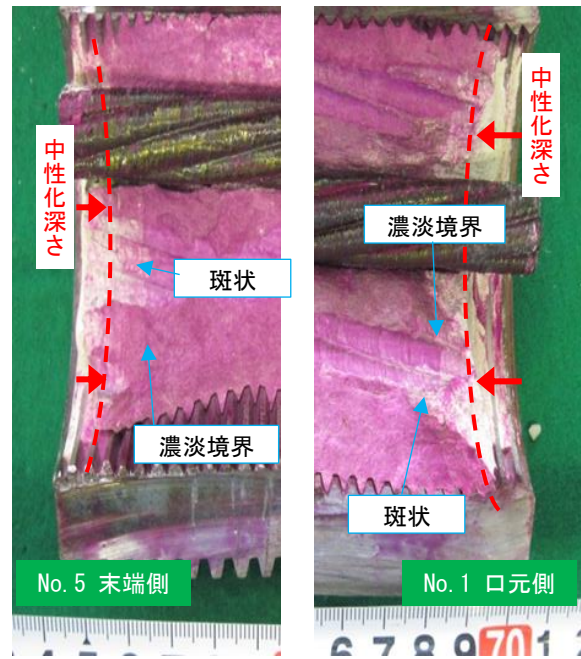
試験体 No.1 と No.5 の未発色部分の状態
